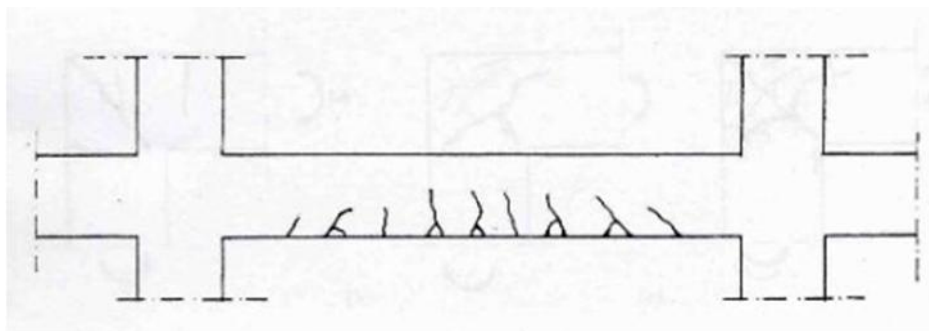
Fissures orthogonales sur l'axe de la poutre le long de la travée dans la zone de tendue [27].
